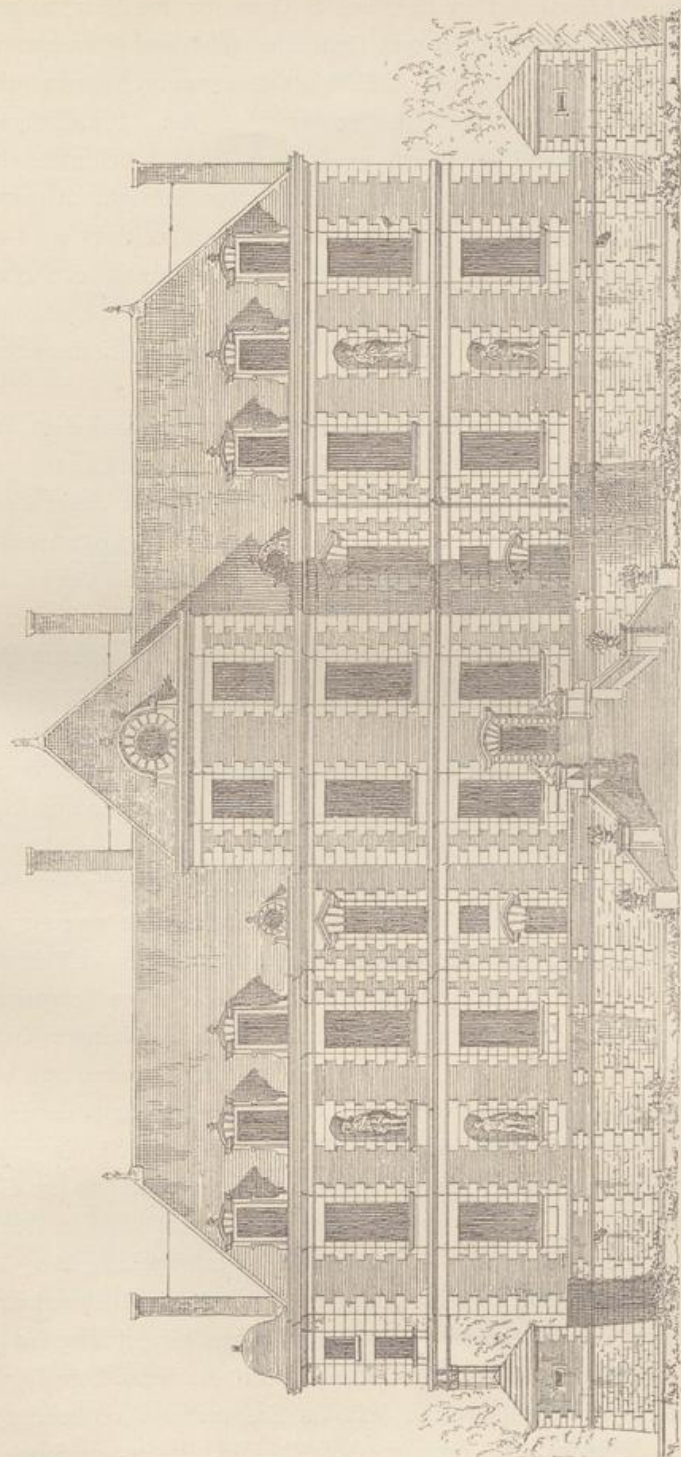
Château de Wideville. Parkfaçade (n. Sauvageot).
